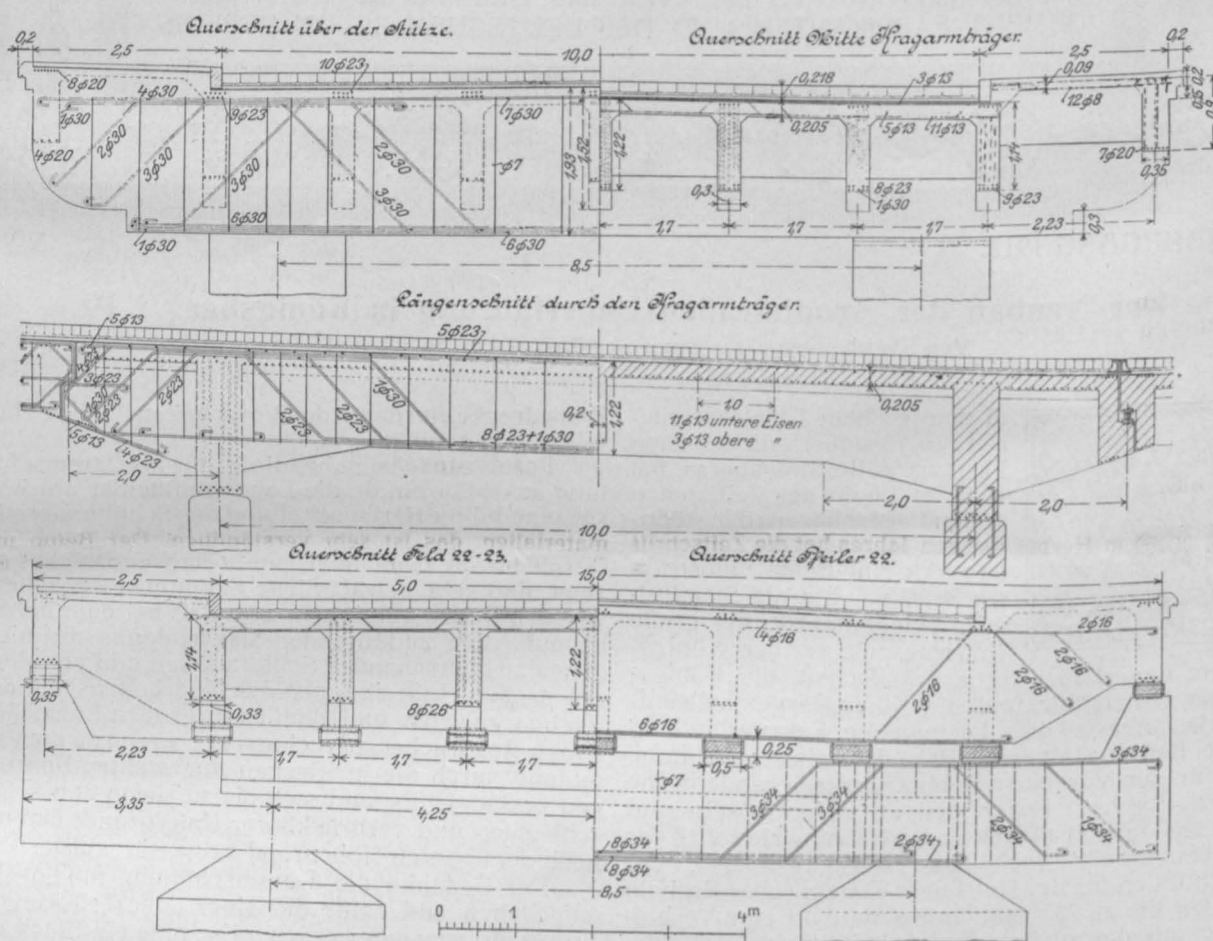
Einzelheiten der Konstruktion und der Bewehrung.
